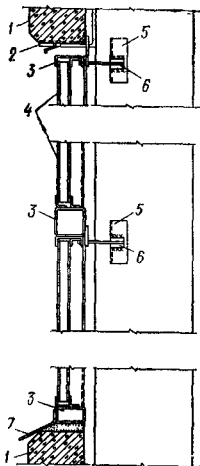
Крепление стеклопанелей серии 1.436-8 к железобетонной колонне
